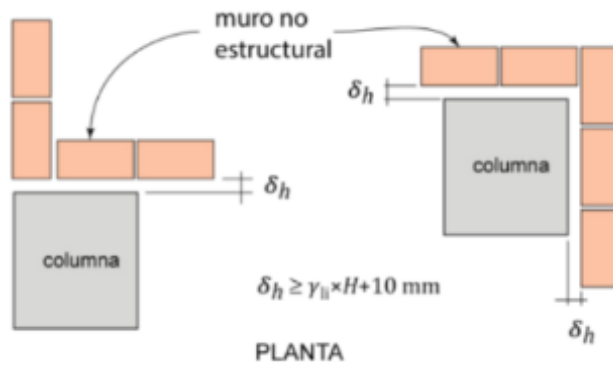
Ejemplo de vista en planta de curtain walls. Recuperado de: Normas técnicas complementarias para diseño y construcción de estructuras de mampostería
